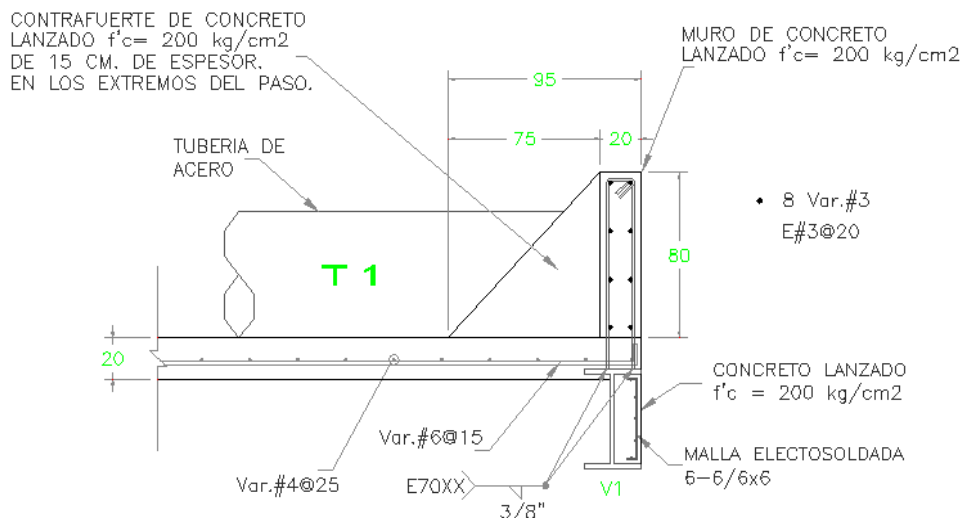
Contrafuerte de concreto lanzado
